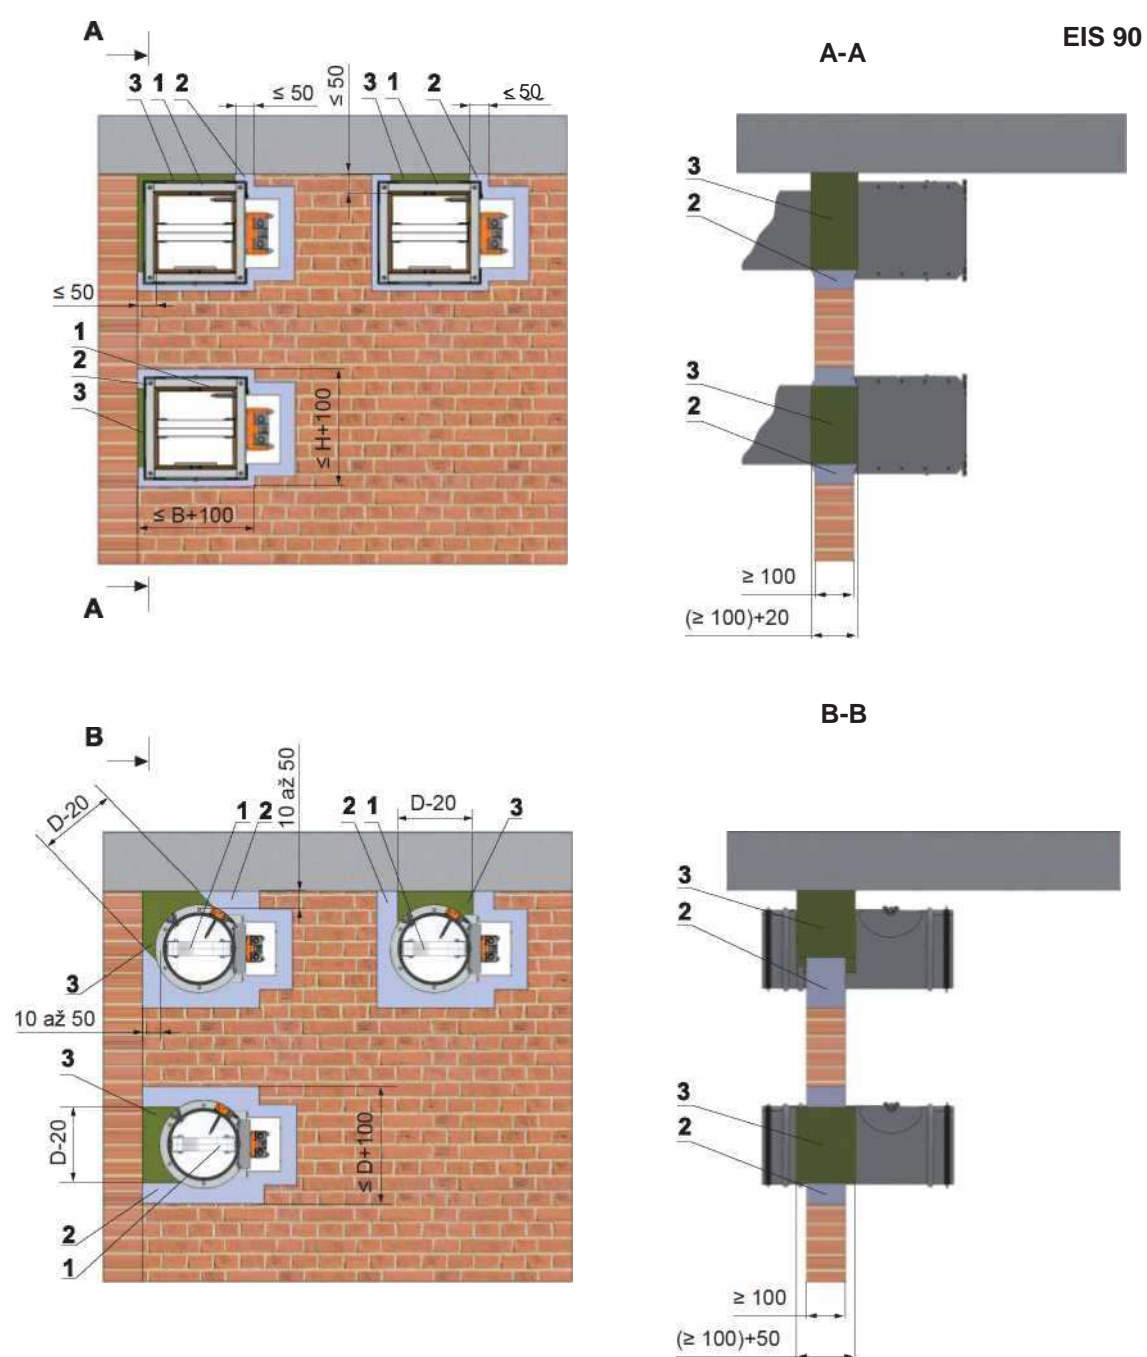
Tuhá stěnová konstrukce - sádra nebo malta
